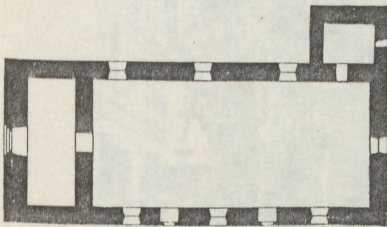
Fiddichow; Kirche, Grundriss.
